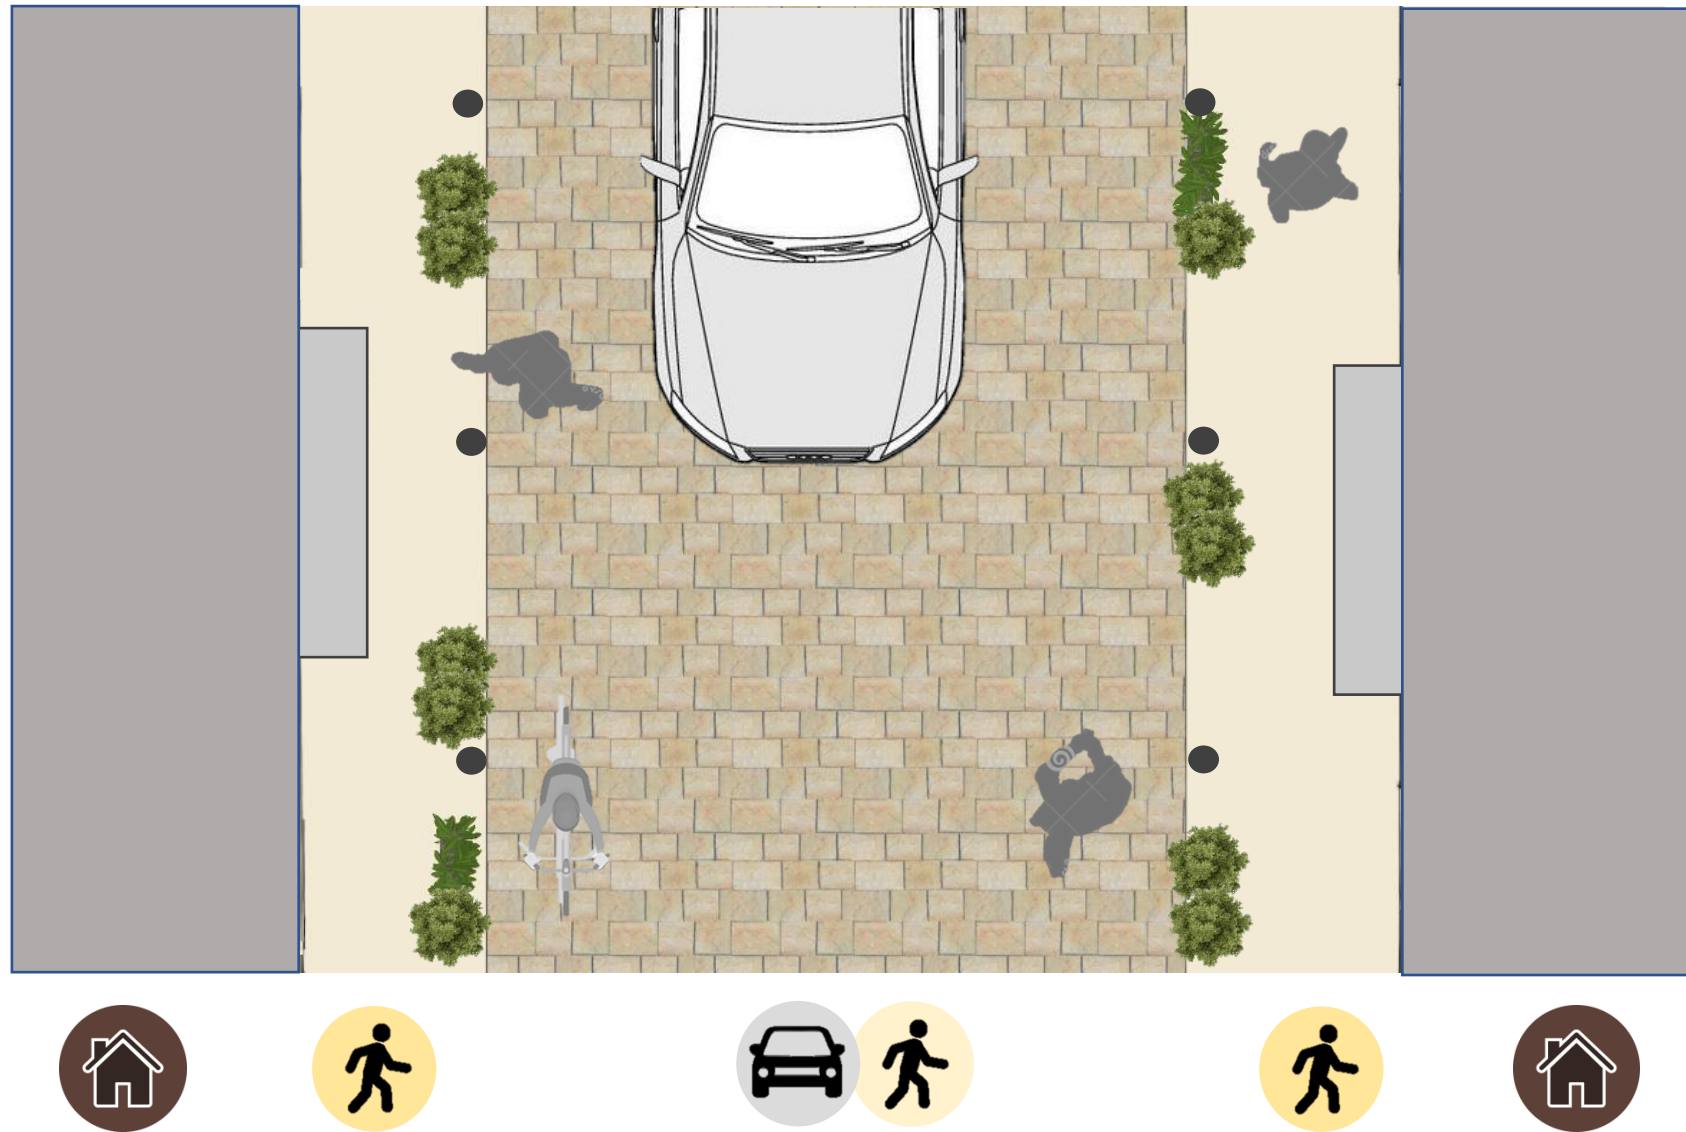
Planta C. Virgen de Lidón. Fuente: Elaboración propia.
